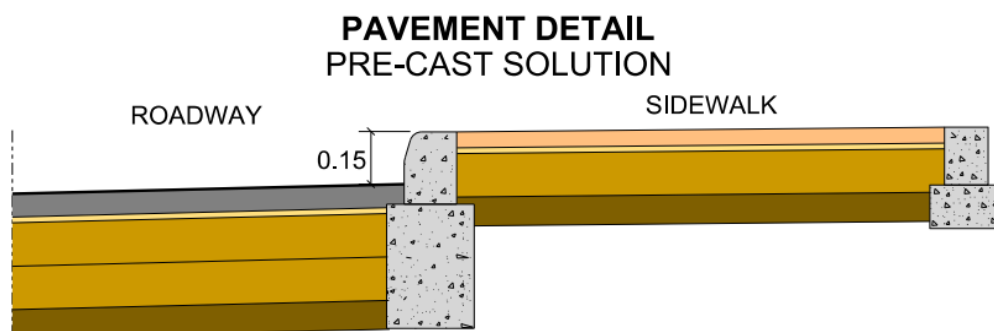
Estrutura de Pavimento da faixa de Rodagem e passeio;
